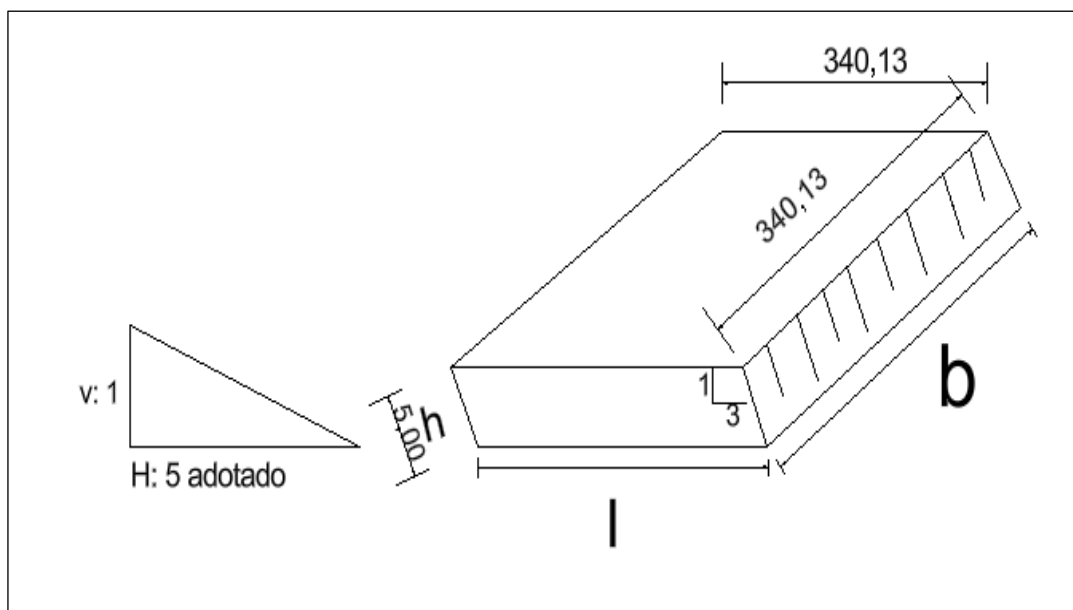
Planta baixa da trincheira da frente de operação do aterro sanitário
